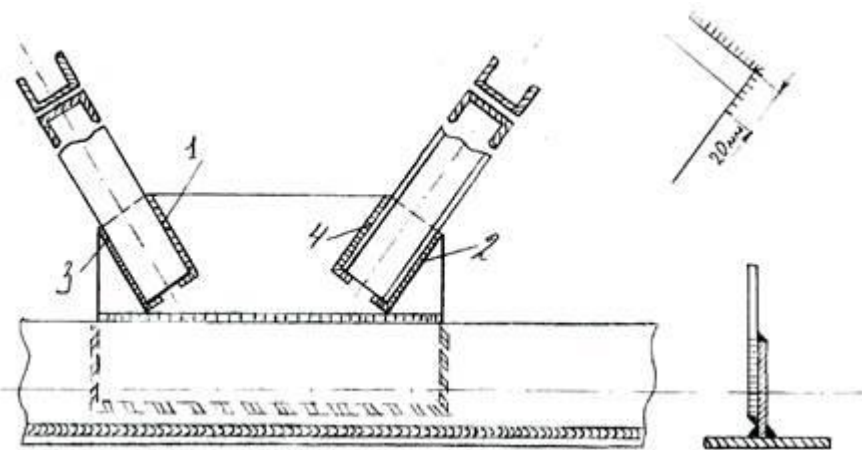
Порядок выполнения флангового (продольного) шва 1-4 - последовательность сварки
